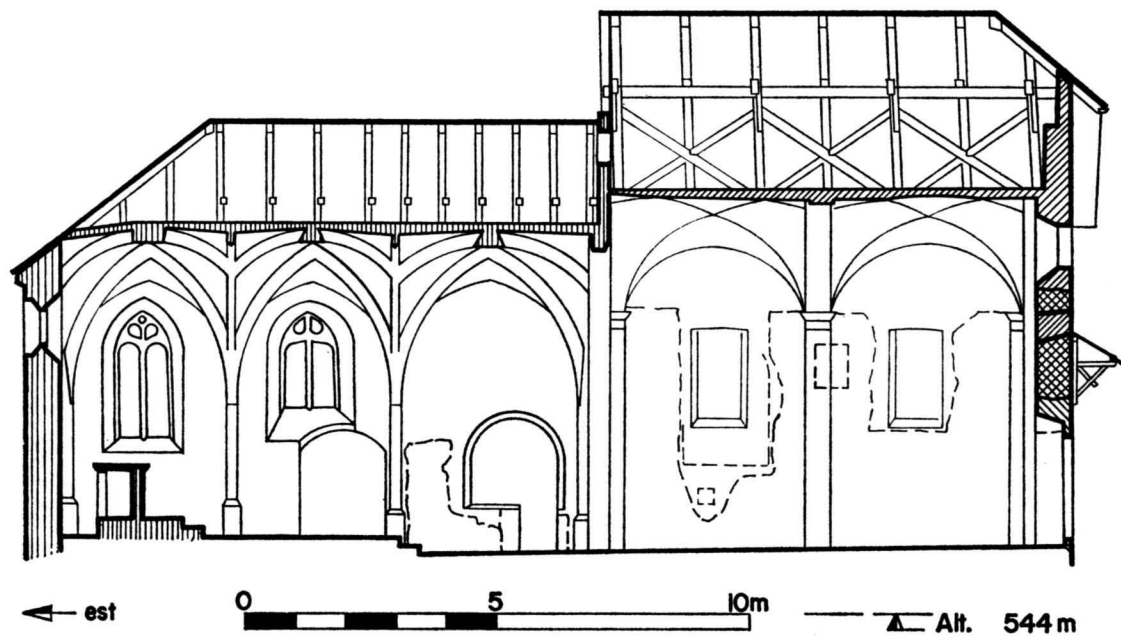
Profil longitudinal (avec élévation au sud, sans la grille et la porte de Saint-Antoine).
